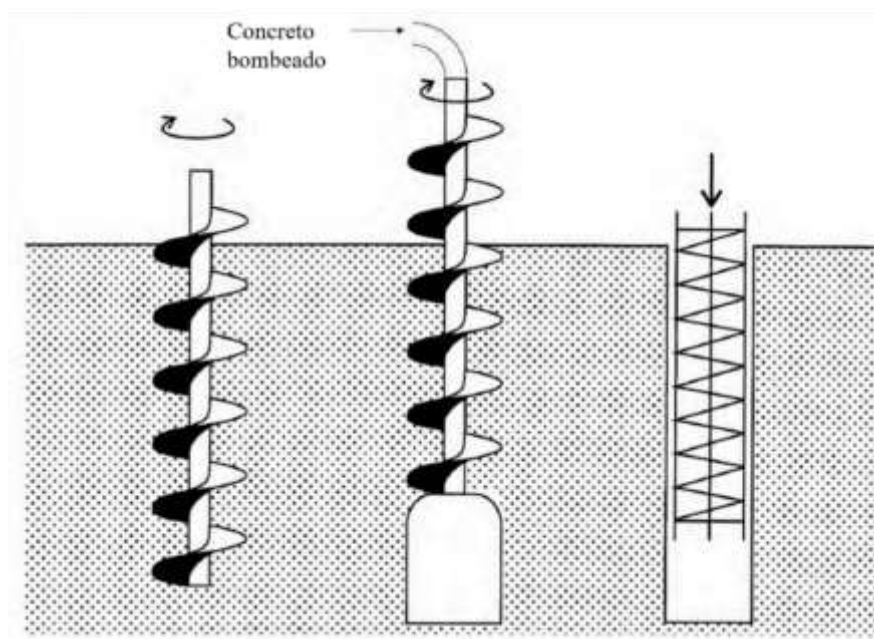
Pilotes según su construcción: (a) Ejecución de pilote tipo excavado, (b) tipo raíz y (c) hélice continua.
